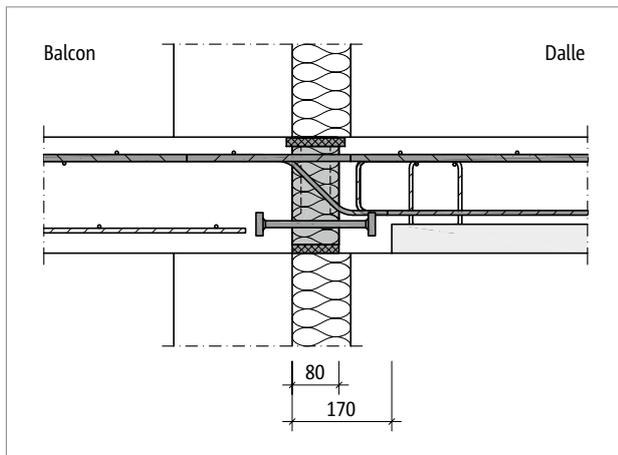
Schöck Rutherma® T type DB : distance minimale par rapport à la façade
